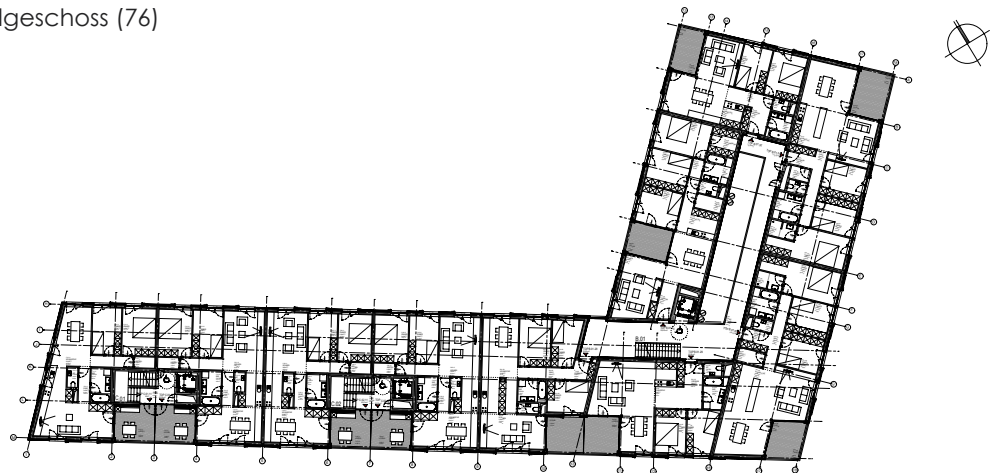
Grundriss Regelgeschoss (76)
